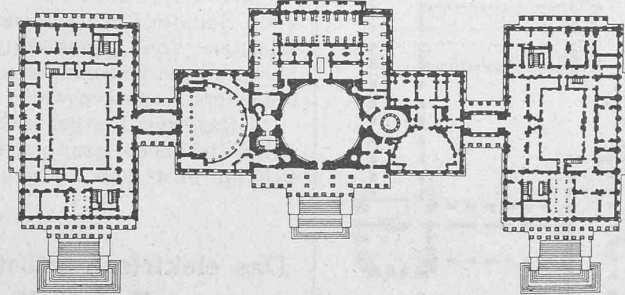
Washington. — Grundriss vom Kapitol. 1:2500.
